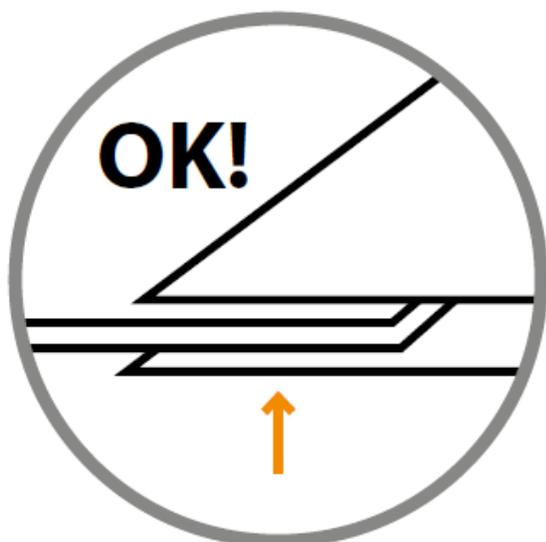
Правильное перекрытие краев отдельных матов AluMat при укладке в полосу один за другим. Ширина перекрытия
